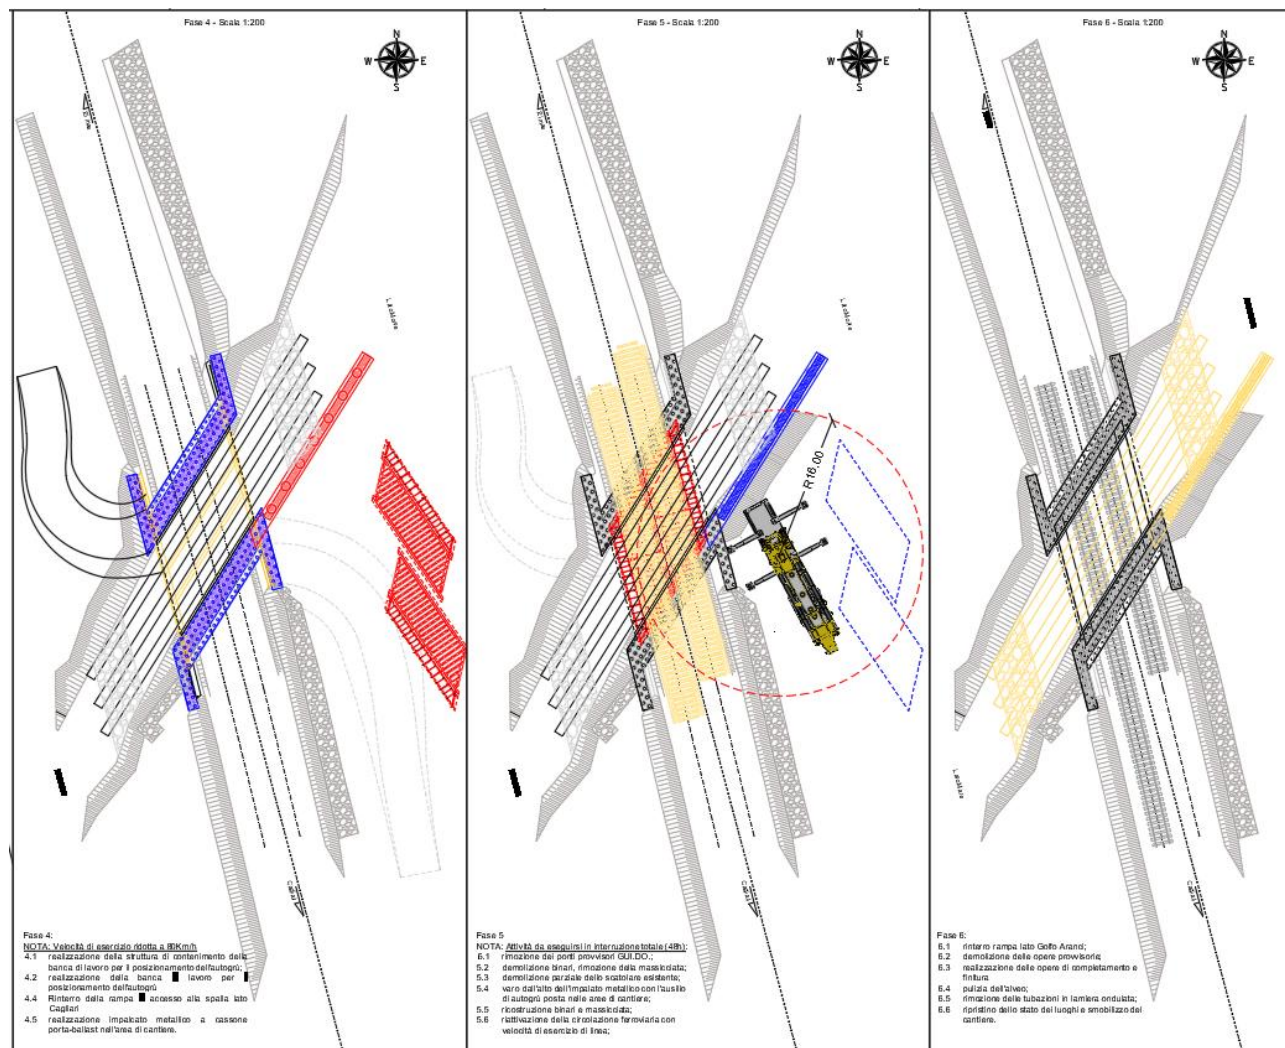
Stralcio planimetria fasi 4 -5-6.
